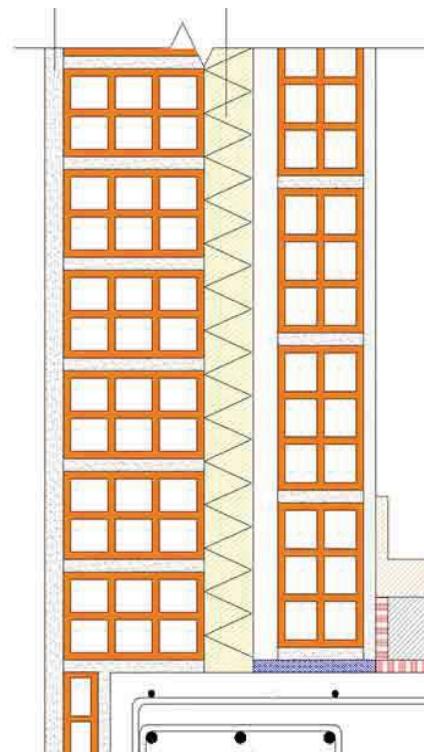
Corte transversal de una construcción a base de cerramientos de fábrica de ladrillo y forjados de hormigón
